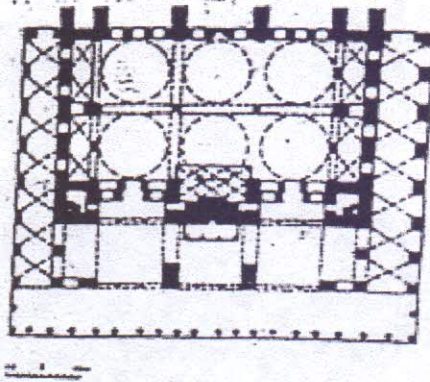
مسقط أفقي للمشهد القبلي بأسوان
